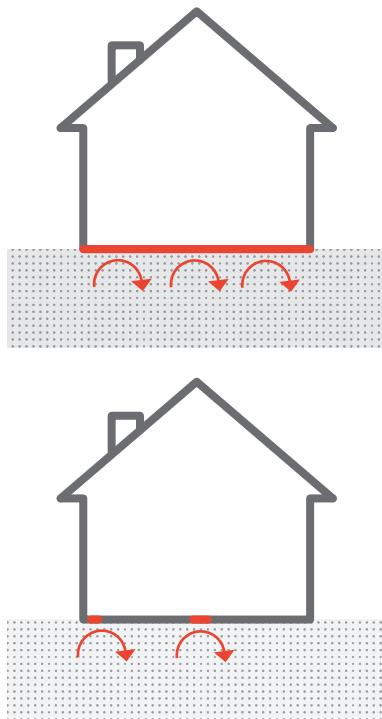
Barrera de protección frente al radón (arriba) y sellado de fisuras, grietas, encuentros y juntas (abajo)
